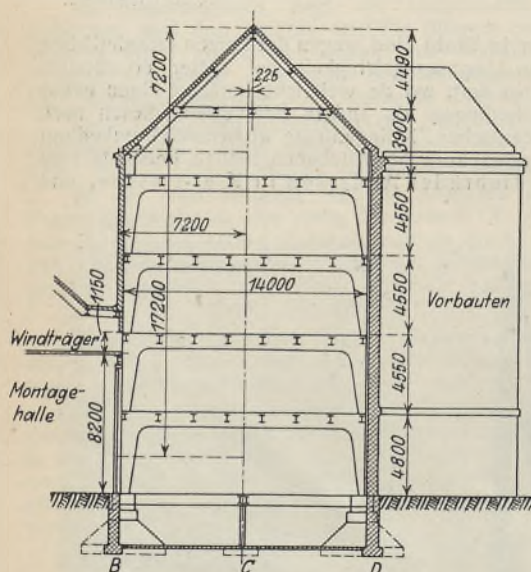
Fabrikgebäude in Kiel. Querschnitt.
